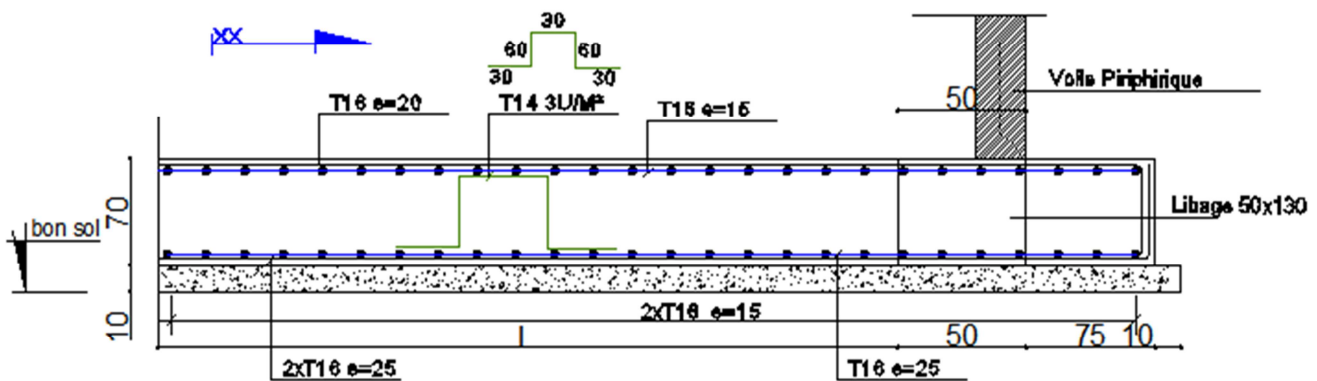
c.: Schéma de Ferrailage du radier a
